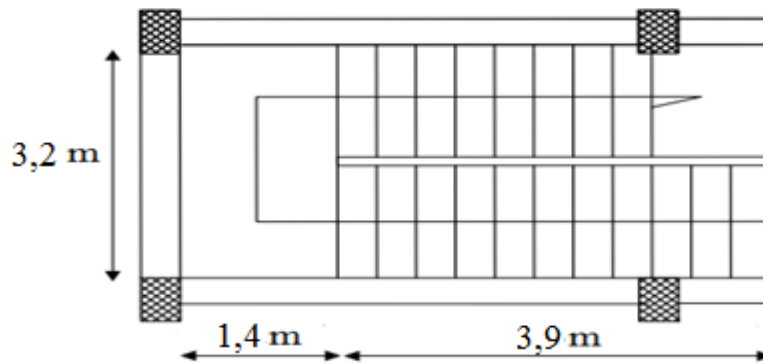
Vu en plan de l'escalier (Type 1).
